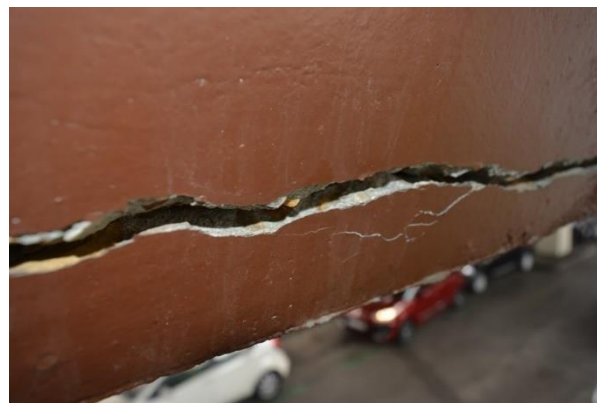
Grieta en vano 6 (suroeste de la estructura). Foto de los autores, 12 de febrero de 2020.
